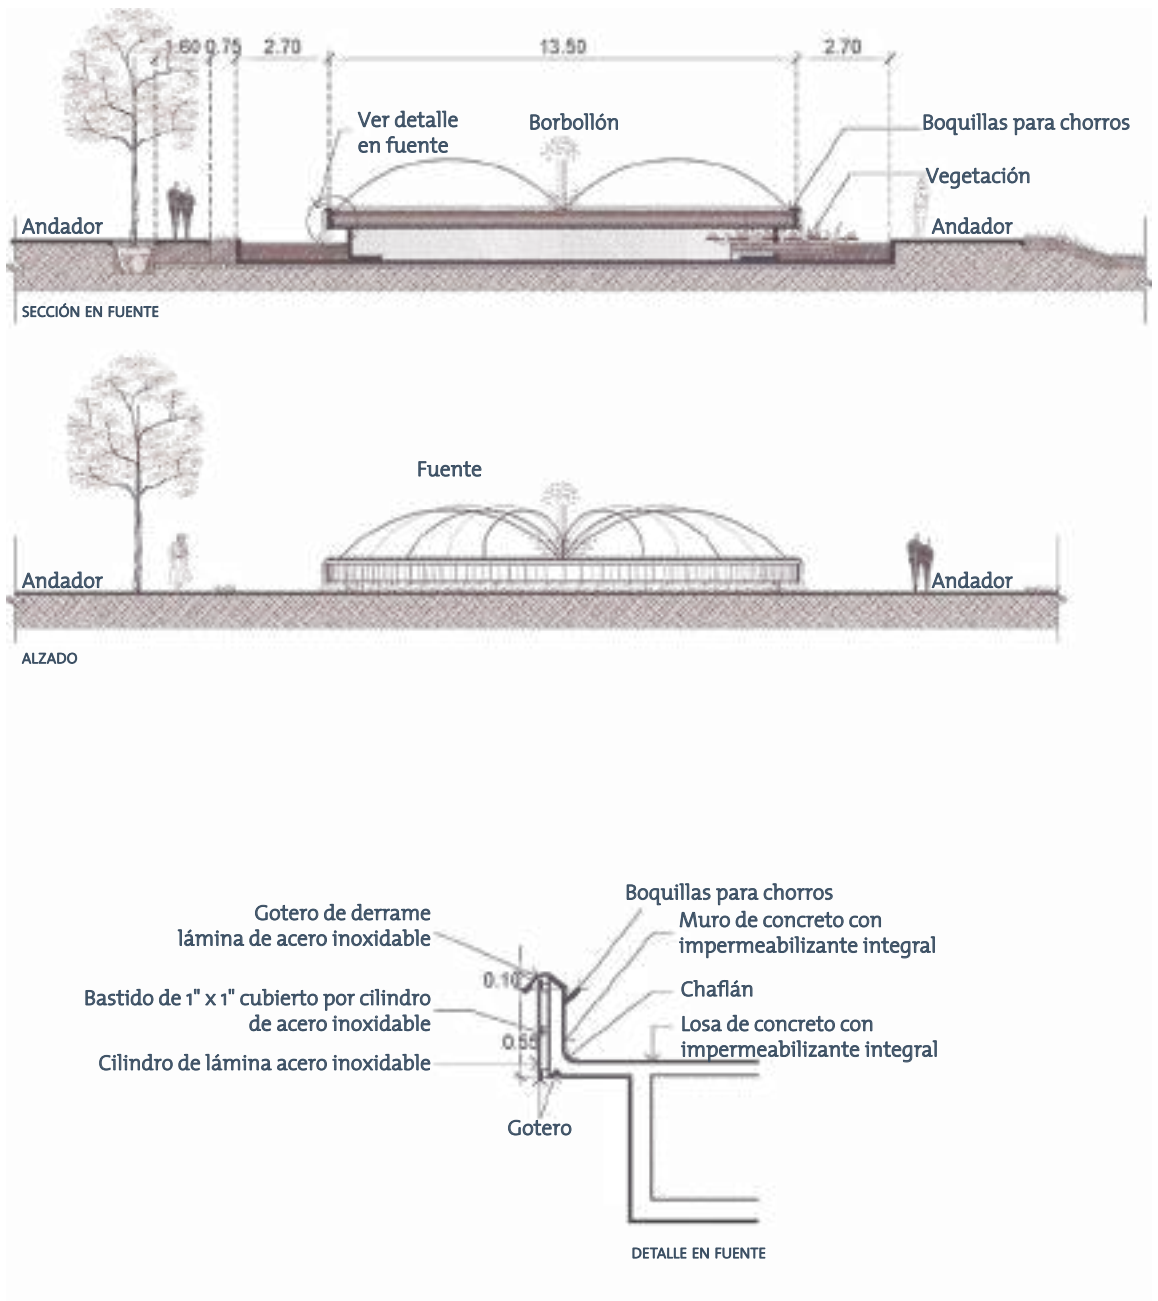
Detalle de fuente. Corporativo Cemex, Monterrey, Nuevo León
